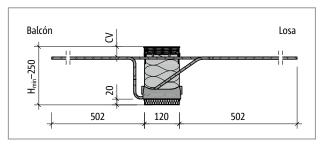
Schöck Isokorb® XT tipo K-M5, M6: Sección del producto
